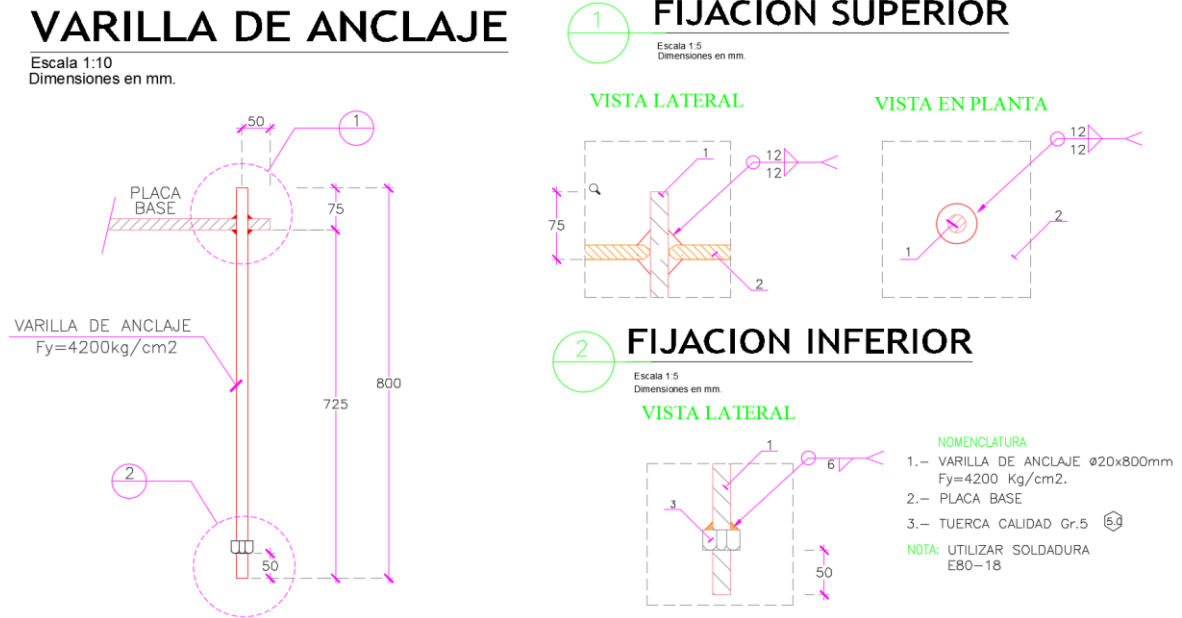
Detalles de Varilla de anclaje soldada
